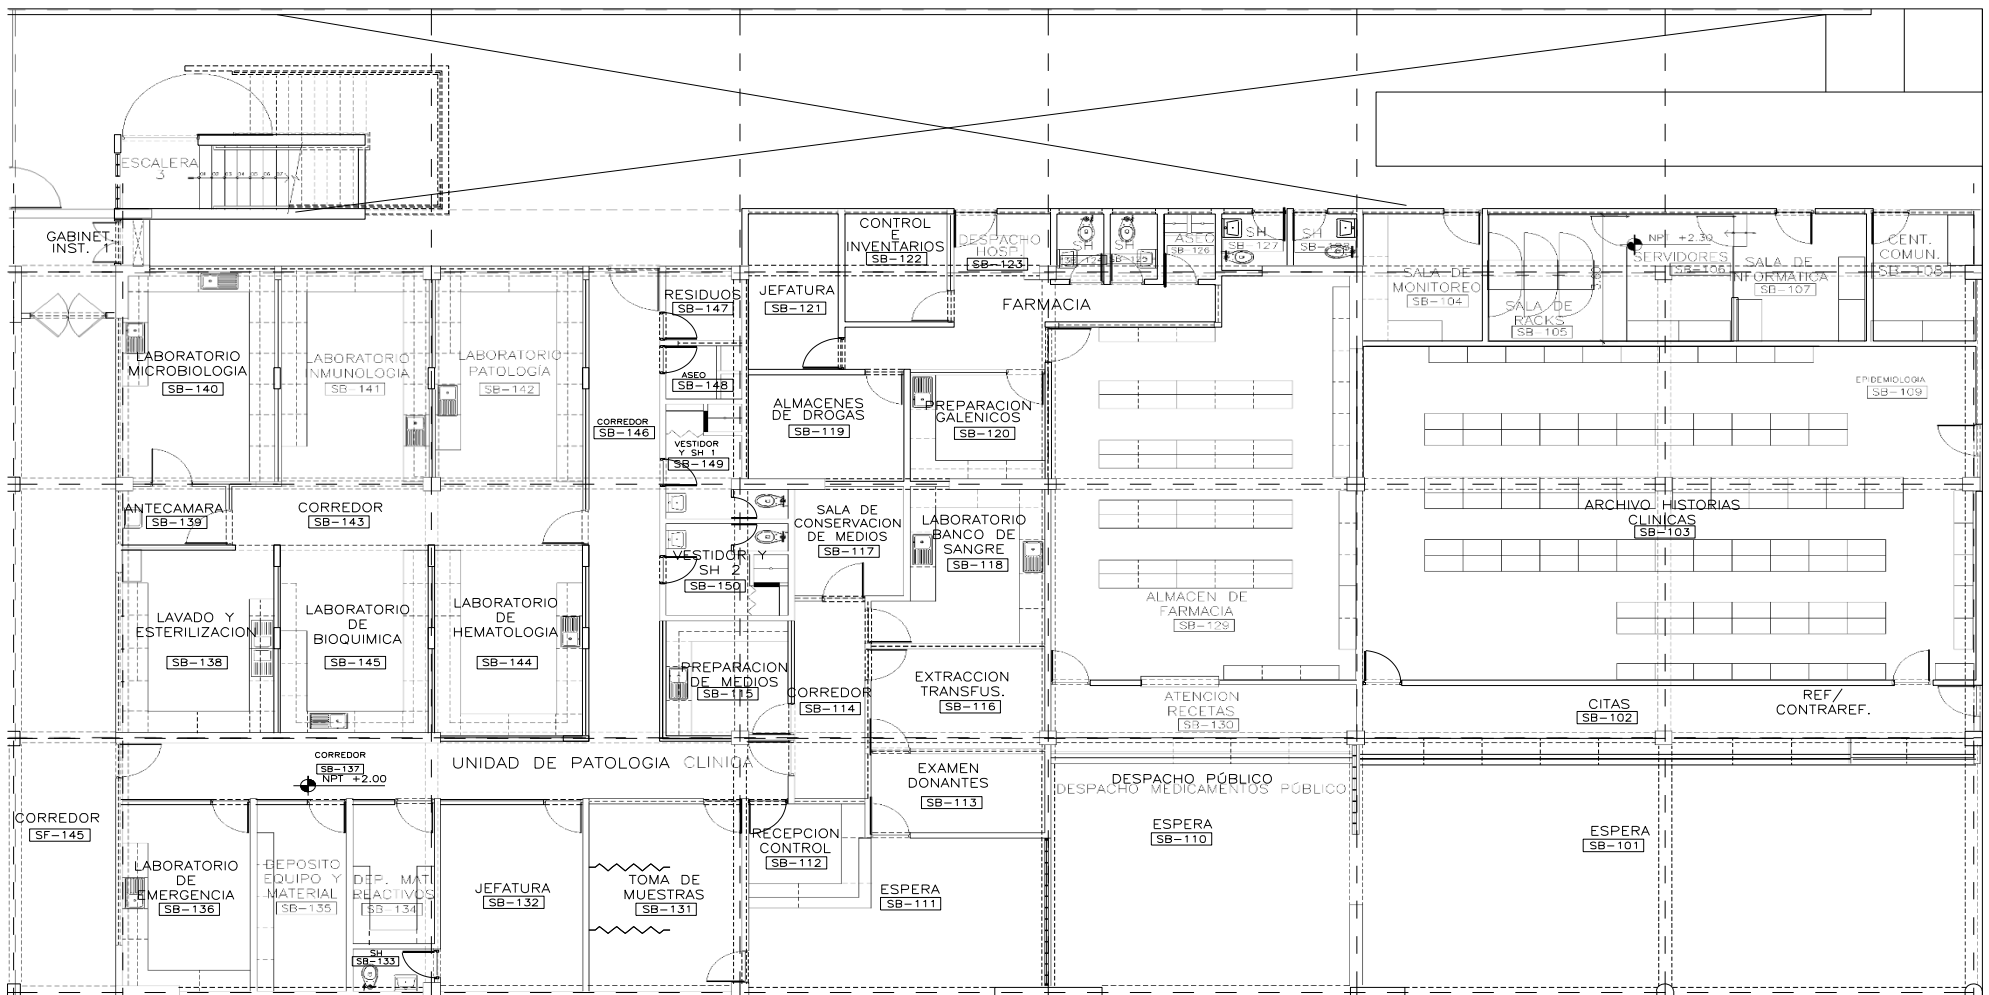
Vista en planta del hospital Luis Negreiros Vega.
